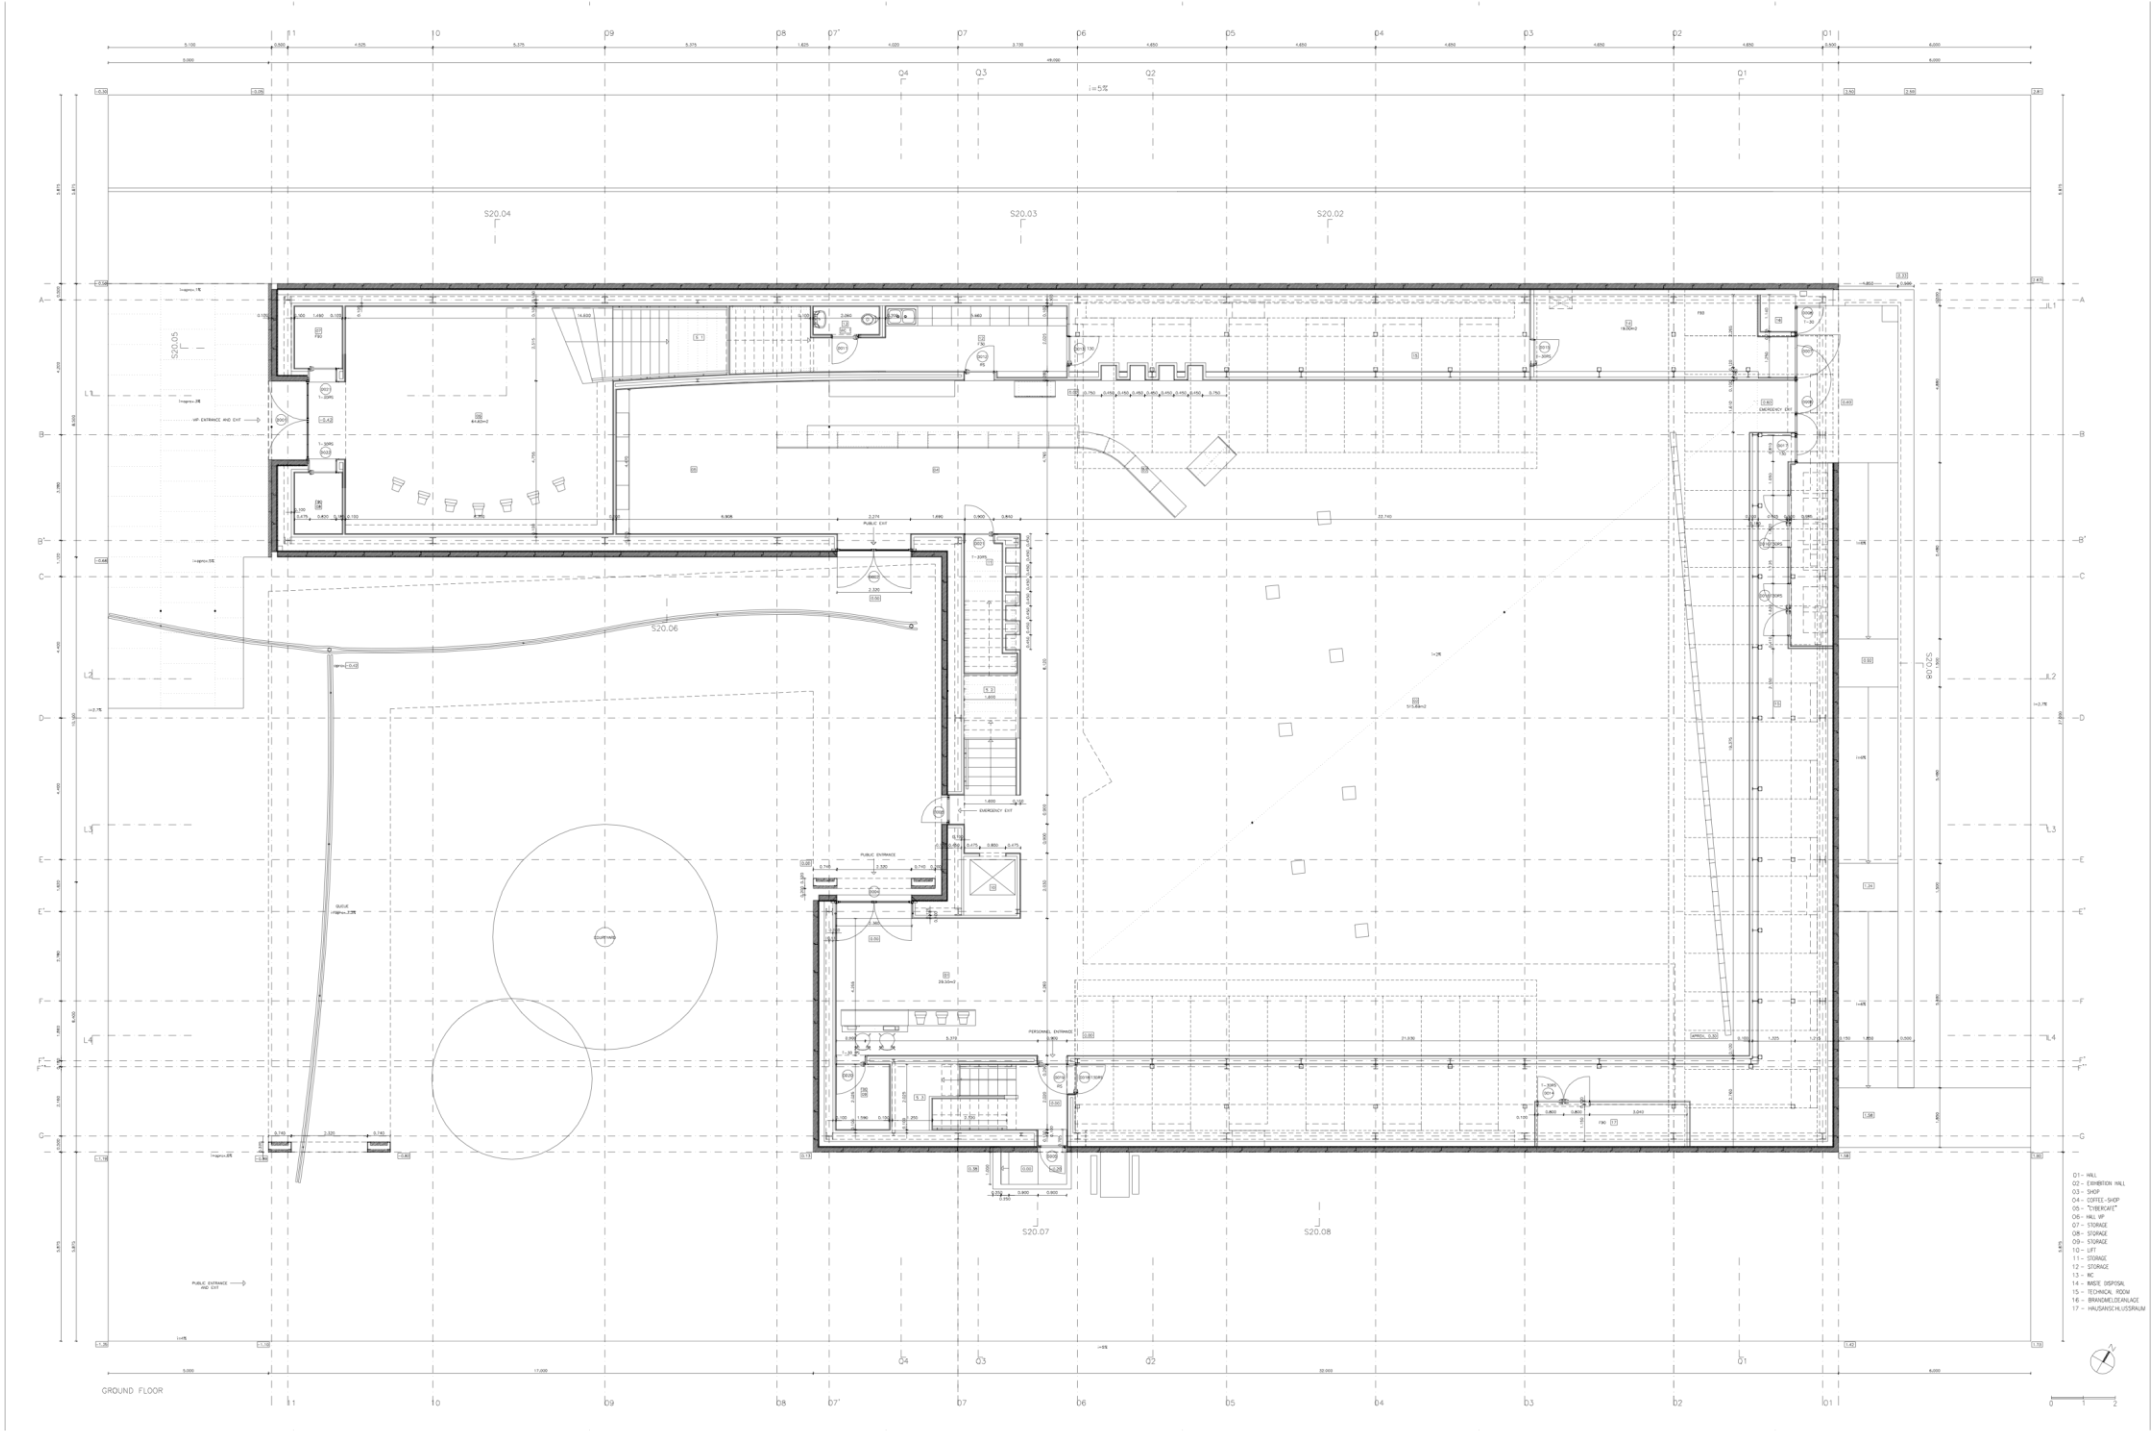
Planta piso 0, Pavilhão Centro de Portugal, (Souto Moura Arquitectos, 2015)
